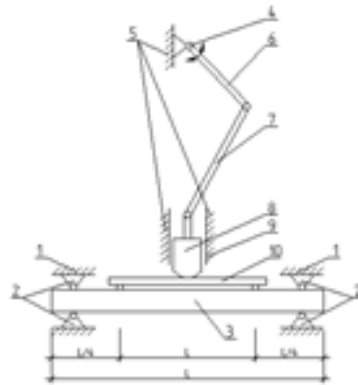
Электромеханическая установка для испытаний строительных конструкций по наклонному сечению
